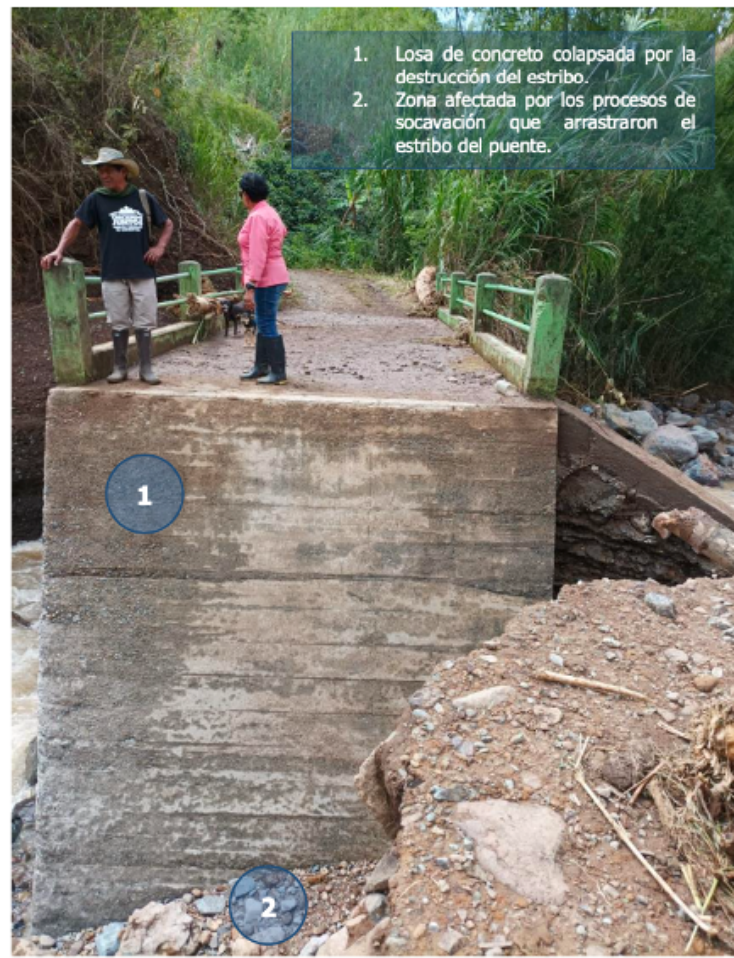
Puente colapsado sobre el Río Arcón vía “La Loma- Pasmí”
